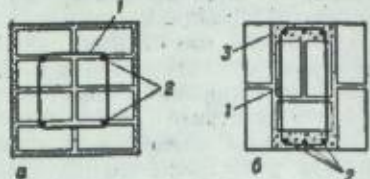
Продольное армирование кладки: а — внутреннее расположение арматуры; б — расположение арматуры в штрабе кладки; 1 — хомуты; 2 — вертикальная арматура; 3 — раствор.
